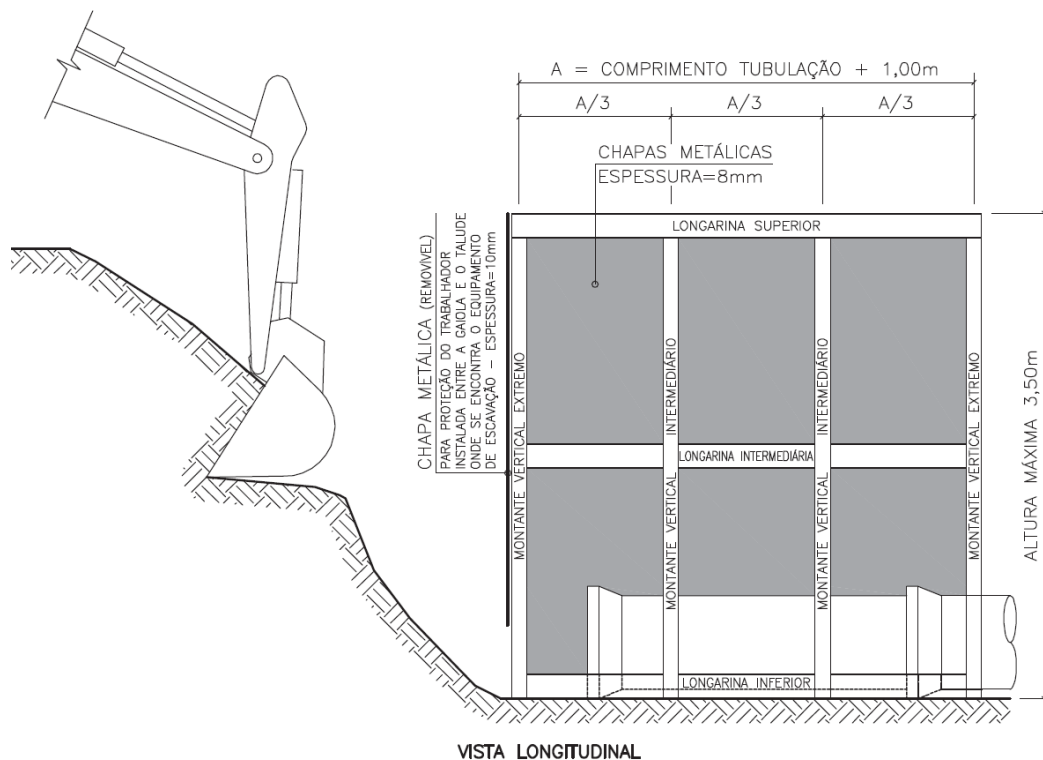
Detalhe em corte do escoramento metálico tipo blindagem (gaiola)
